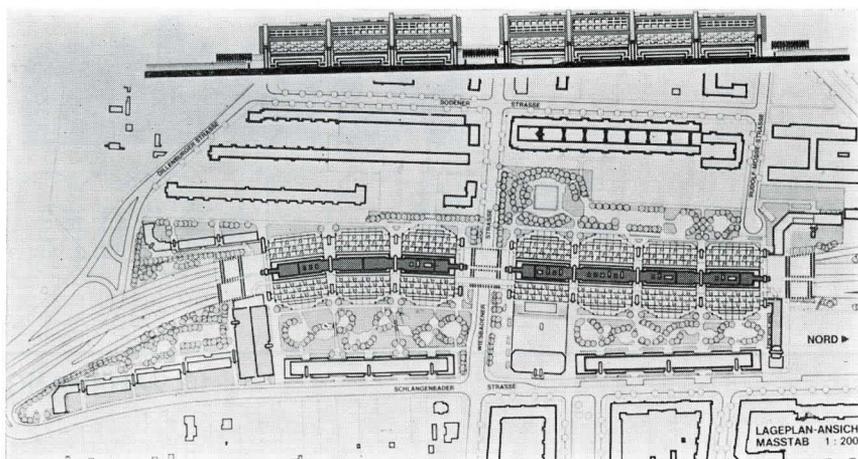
Grundriß und Ansicht der Autobahnüberbauung an der Schlangenhader Straße
